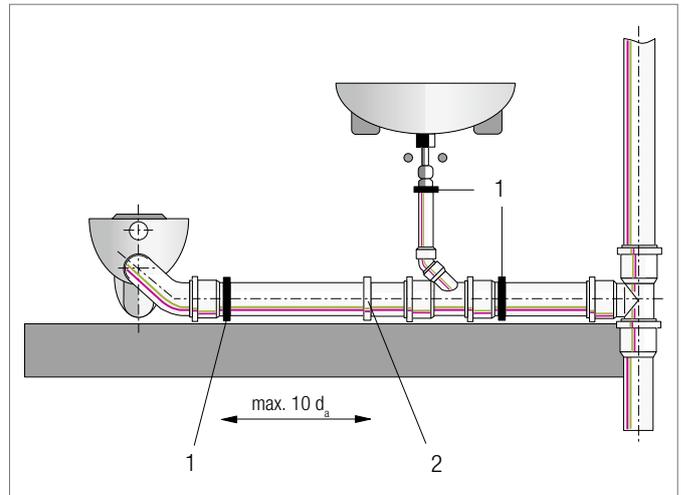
Installationsschema waagerechte Rohrleitung
